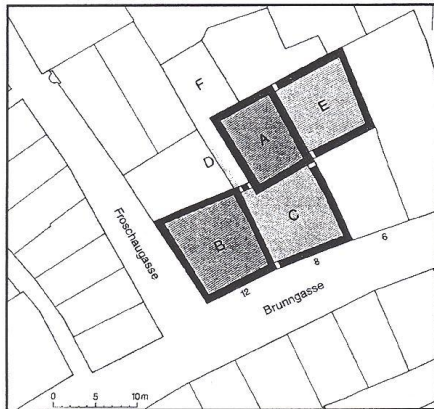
Grundrissentwicklung der Häuser Brunngasse 6-12 (BdD, S. 30)
